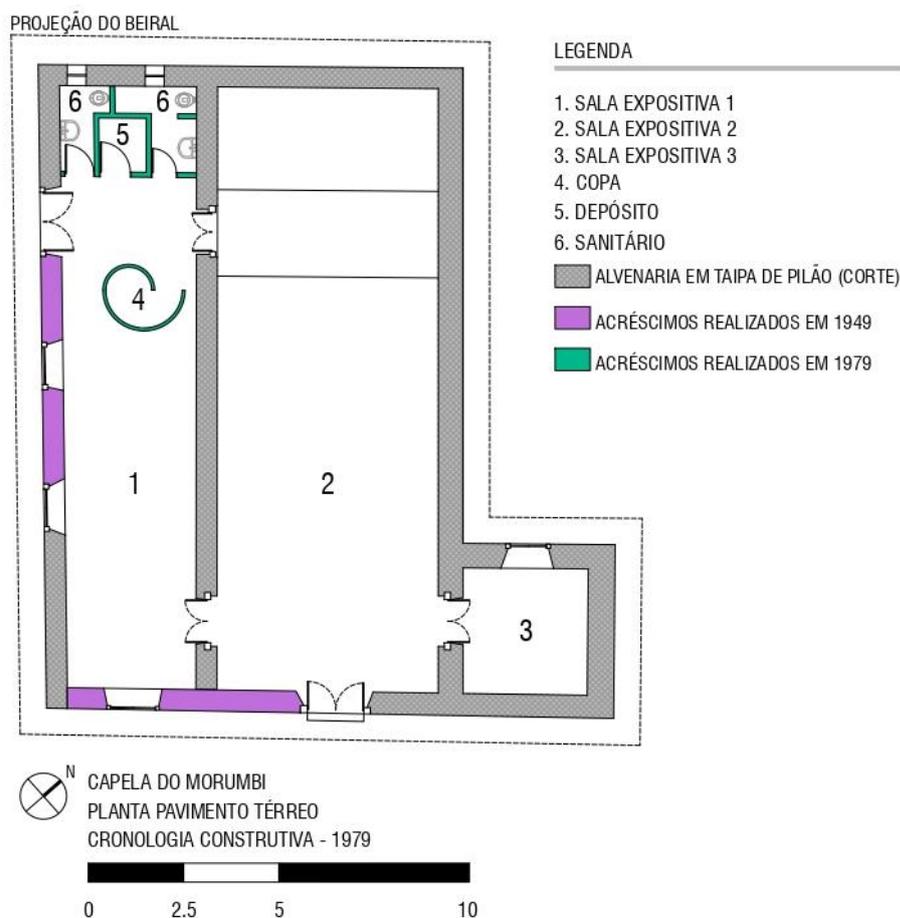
Capela do Morumbi, Planta do atual pavimento térreo com destaque para as intervenções realizadas em 1979 – Cronologia Construtiva. Fonte: Autora.
